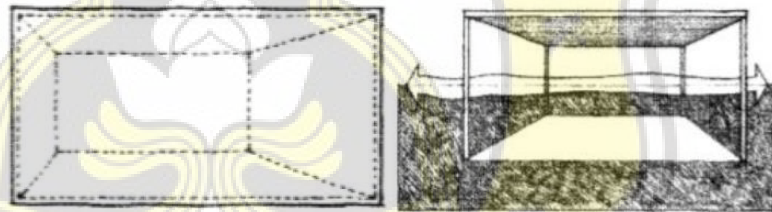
4. Elemen Pembatas dan Pembentuk Ruang Dalam serta Ruang Luar
